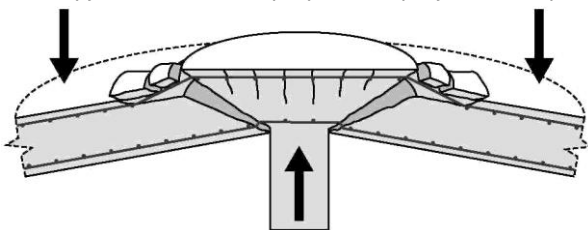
Плоская плита, поддерживаемая колоннами и стенами
